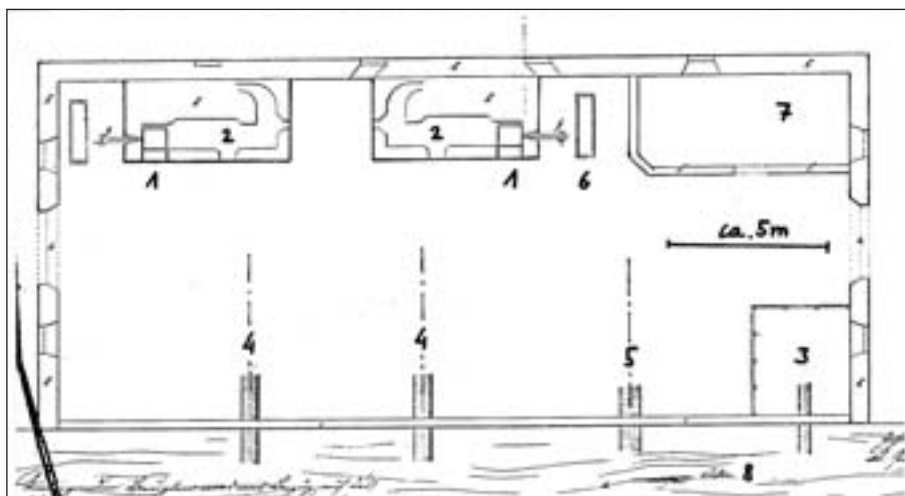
Rottenmann. Frischhütte und Walzwerk Jakob Messners (unvollständiger Grundriss). Ausschnitt aus dem mit 27. März 1848 datierten „Situationsplan des ... zu errichtenden Eisenwerkes zu Rottenmann“; StLA. OBG Leoben L-I-1848
